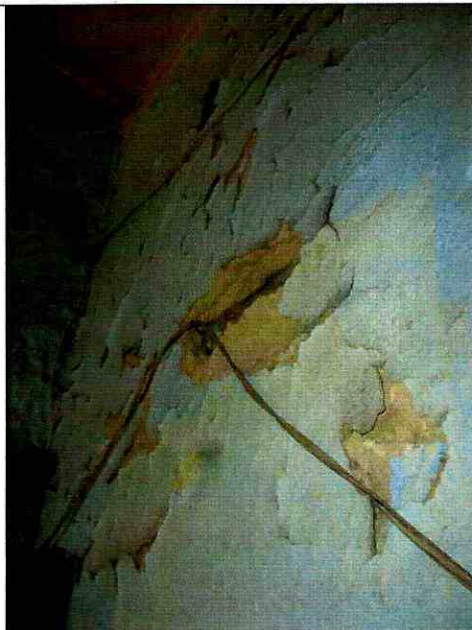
y 12. Daño generalizado en muros y entepiso.
